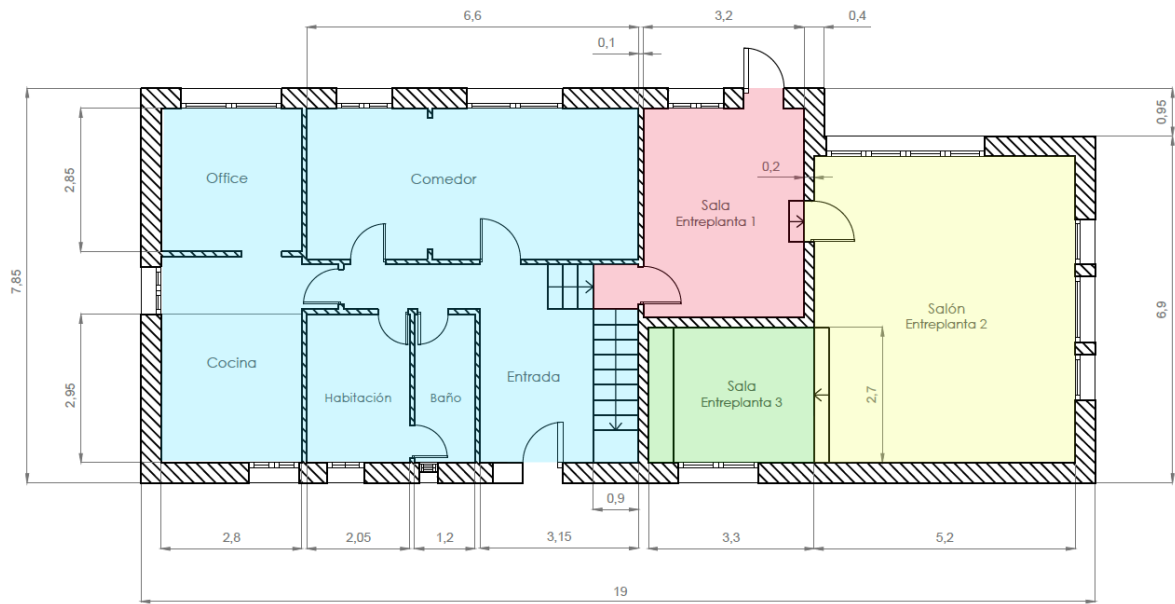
1. Planta Baja: Distribución interior (coloreado) (Fuente: Plano de elaboración propia)
